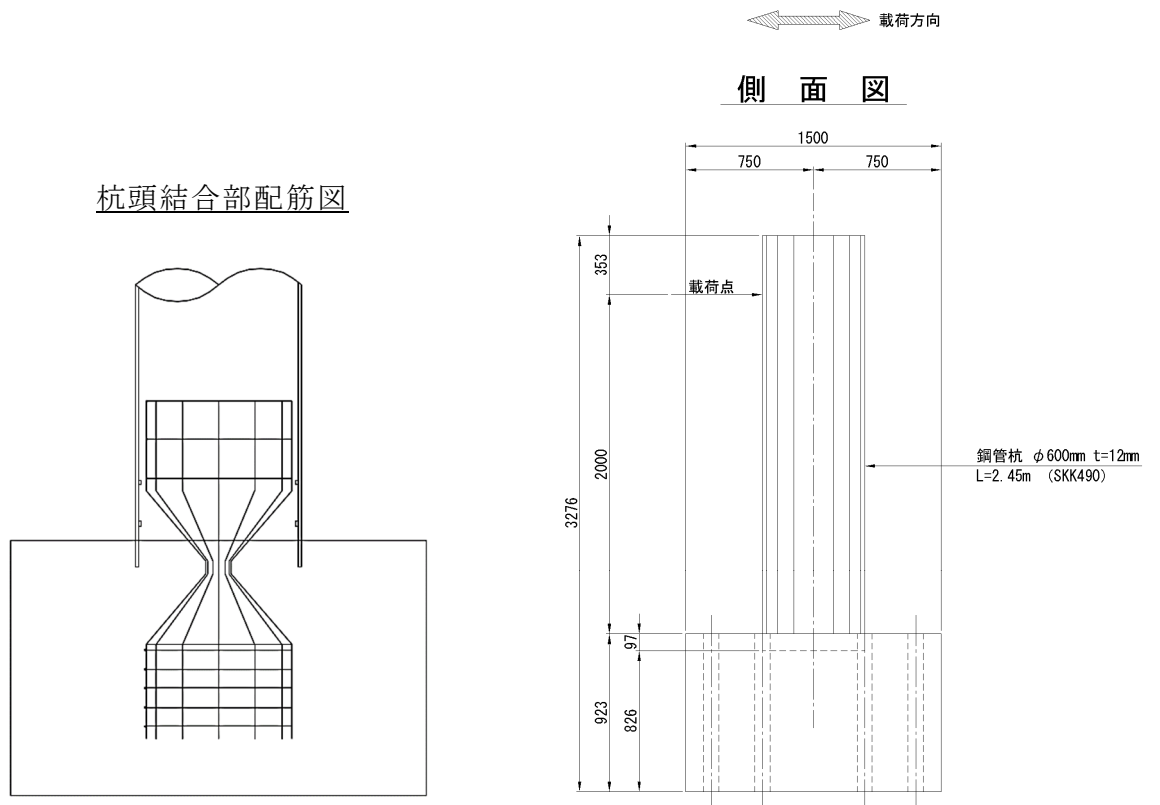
試験体構造図及び杭頭結合部配筋図
